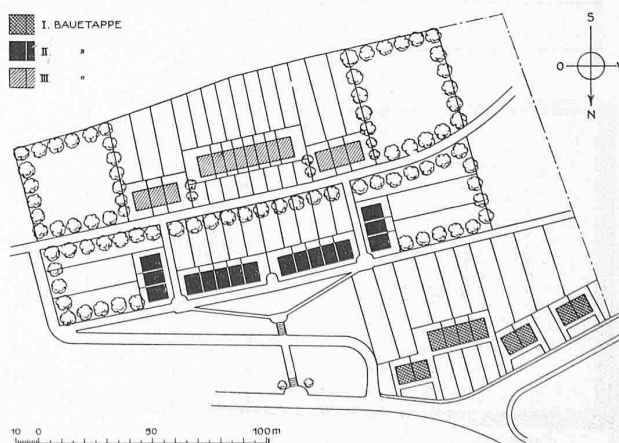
Wohnkolonie Friedberg, Luzern. — Lageplan 1 : 3000.
